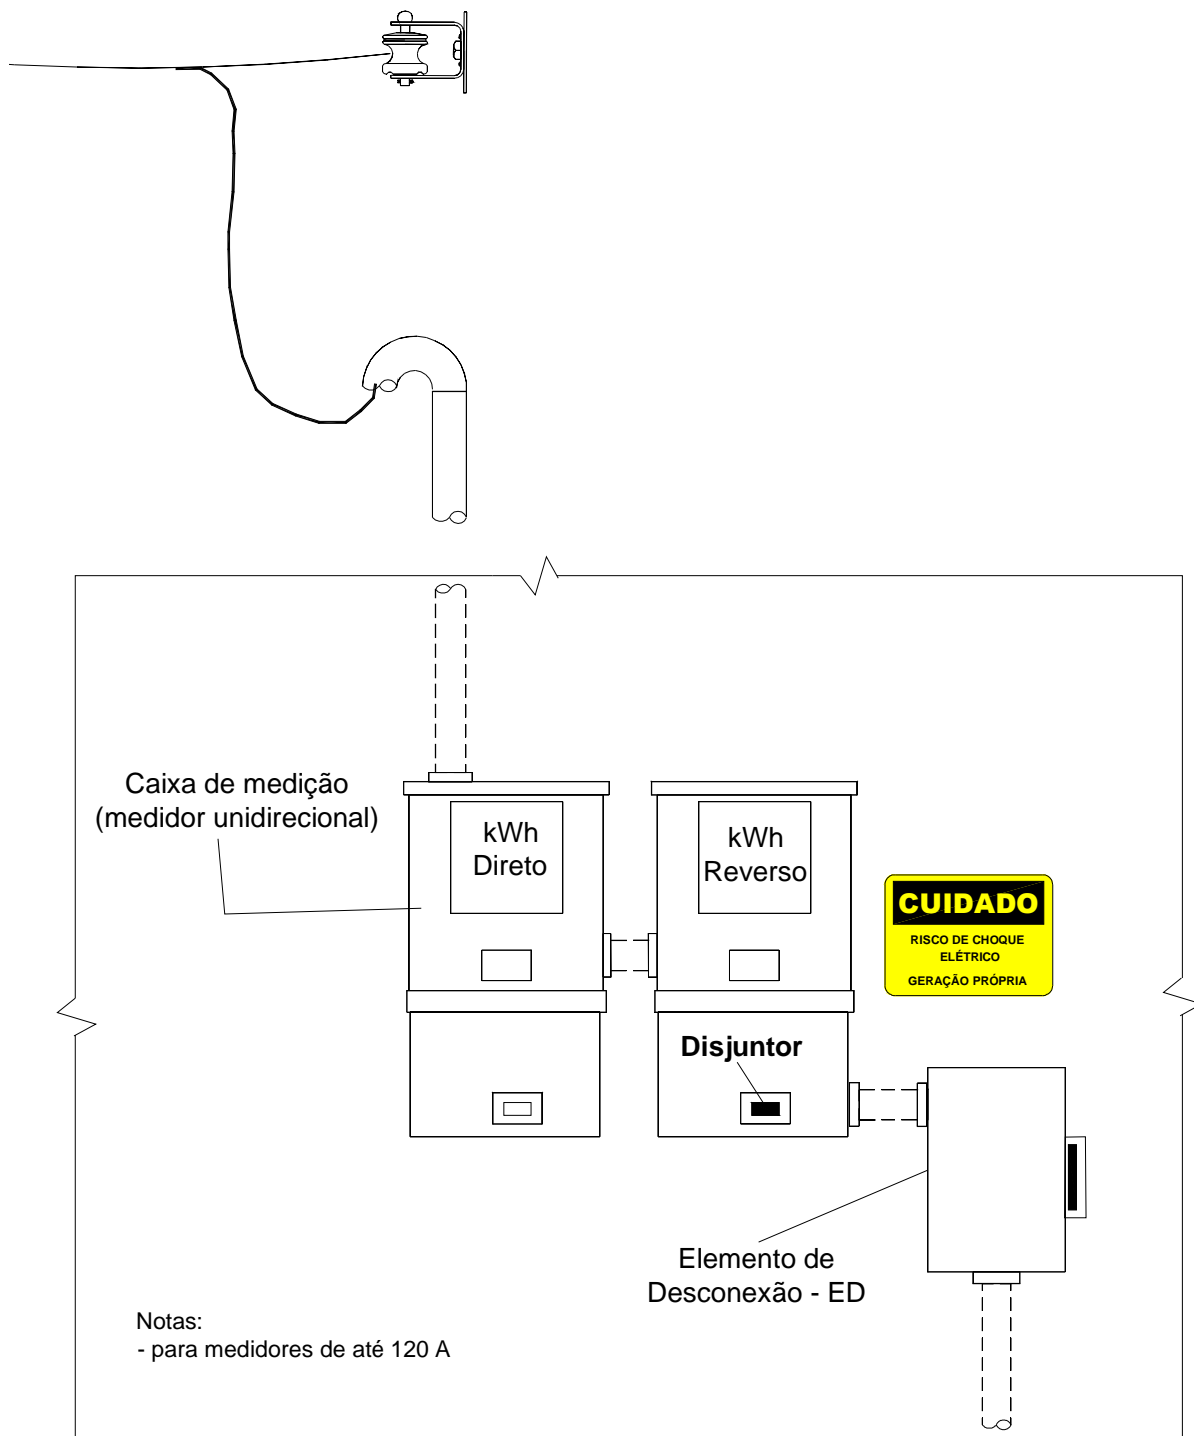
Disposição do Elemento de Desconexão - ED - instalado junto à medição e proteção no padrão de entrada em muro ou mureta - com dois medidores unidirecionais
